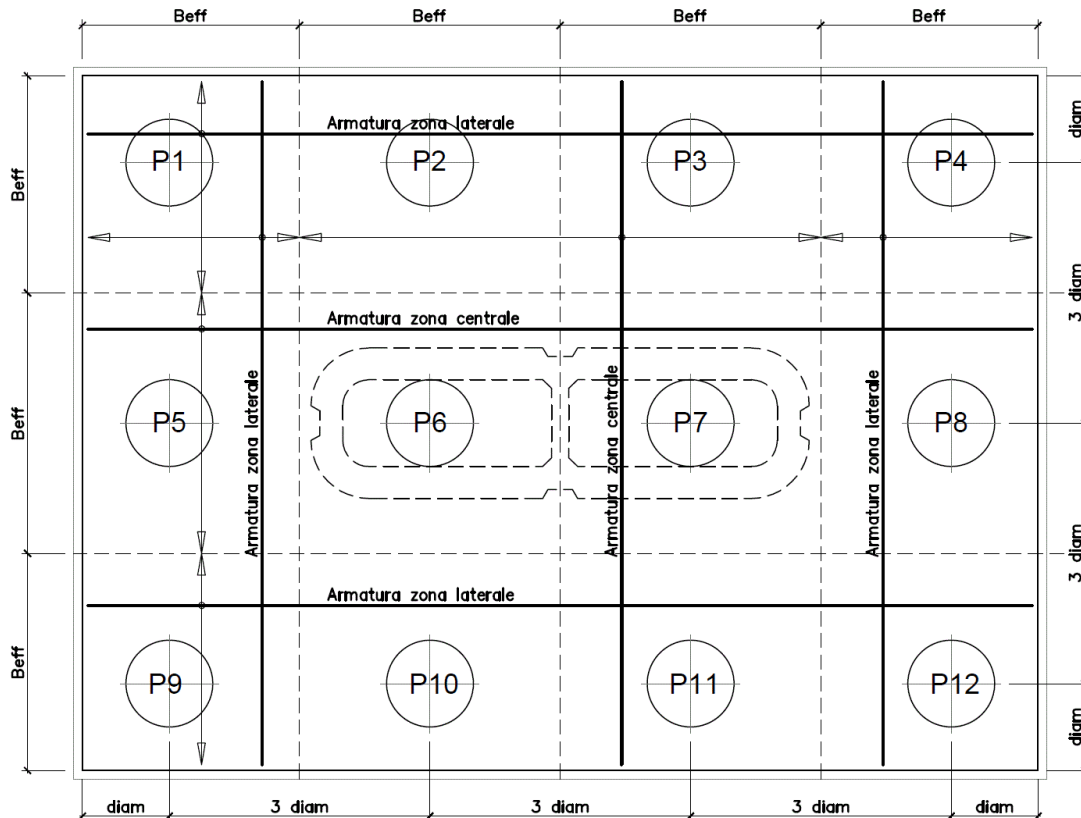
Plinto di fondazione – Armatura longitudinale inferiore e superiore
